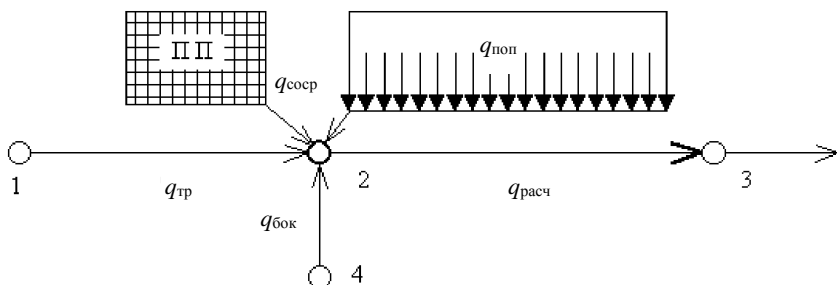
Схема поступления расходов сточных вод на расчетном участке 2–3: ПП – промышленное предприятие
